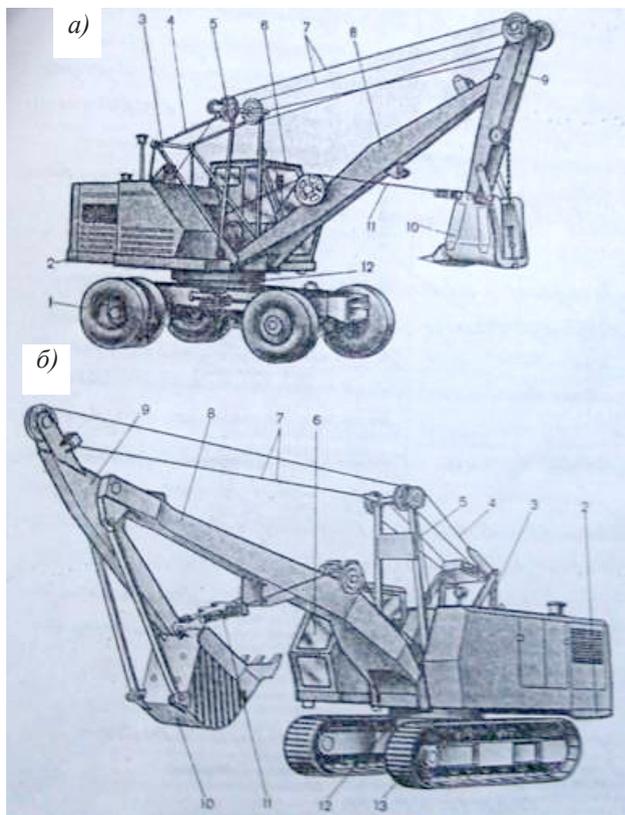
Строительные полноповоротные экскаваторы с механическим приводом и гибкой подвеской рабочего оборудования: а – пневмокошесный ЭО-3311Д; б – гусеничный ЭО-4112; 1 – пневмокошесное ходовое устройство; 2 – поворотная платформа; 3 – двуногая стойка; 4 – стрелоподъемный канат; 5 – передняя стойка; 6 – кабина машиниста; 7 – подъемный канат; 8 – стрела; 9 – рукоять; 10 – ковш обратной лопаты; 11 – тяговый канат; 12 – опорно-поворотное устройство; 13 – гусеничное ходовое устройство
